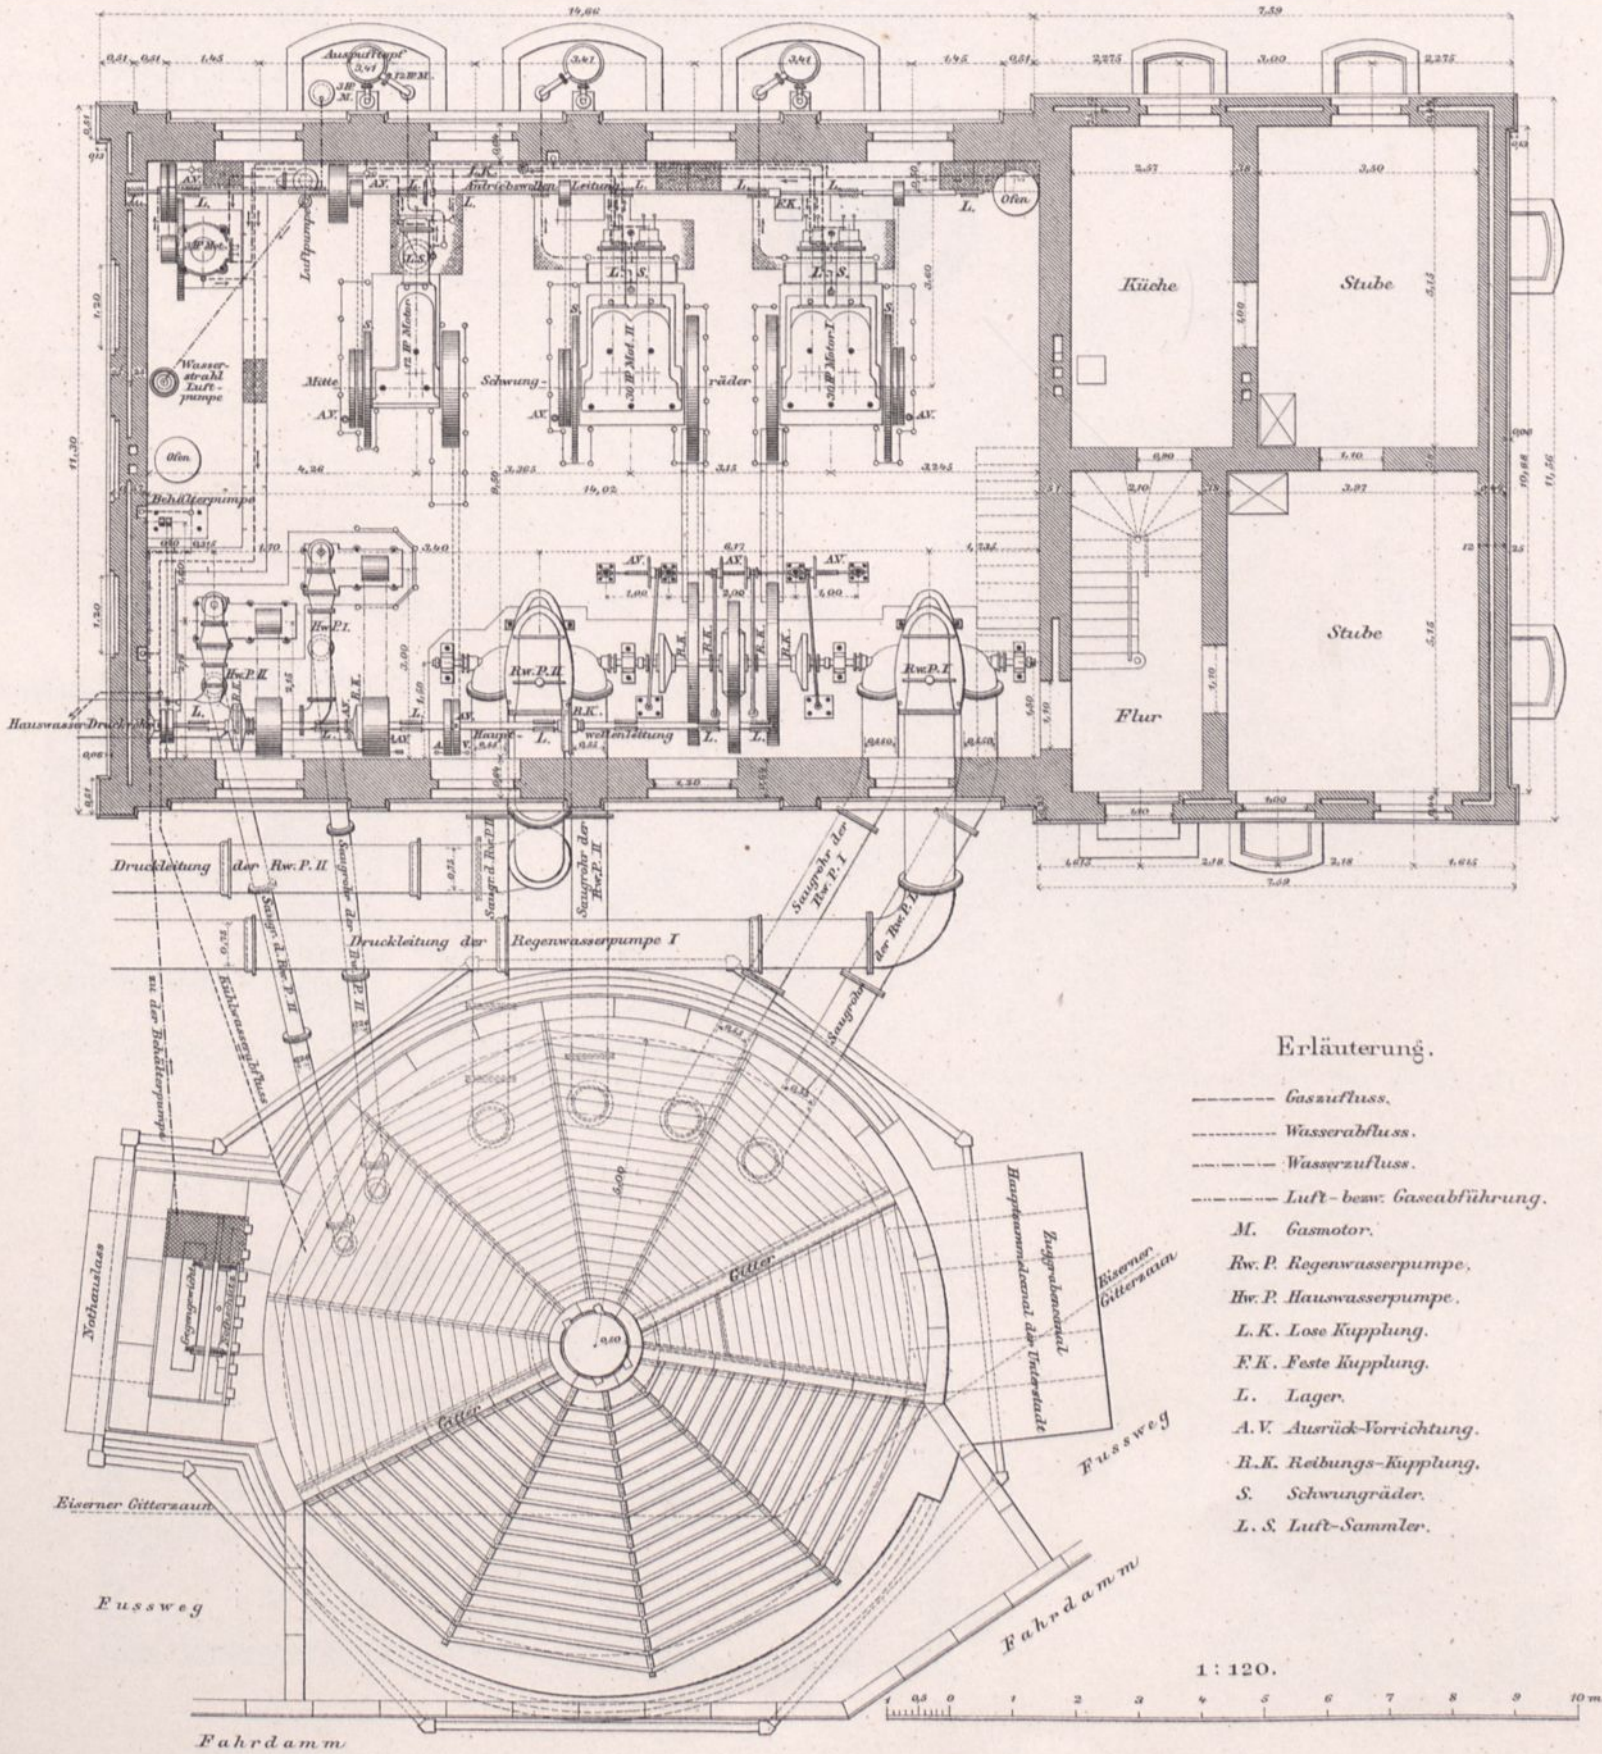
Grundriss vom Maschinenhaus und Sandfang.
